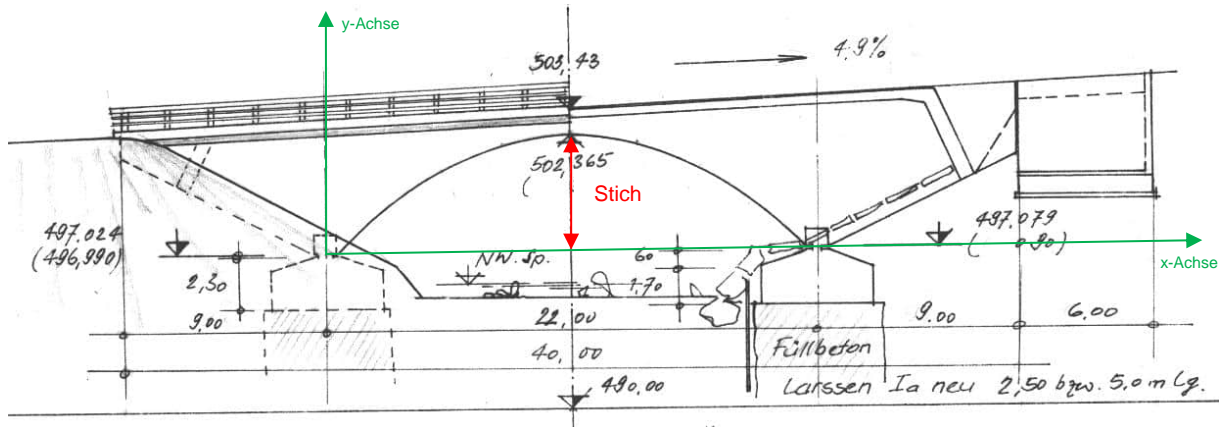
Brücke mit Bogenscheiben aus Stahlbeton
